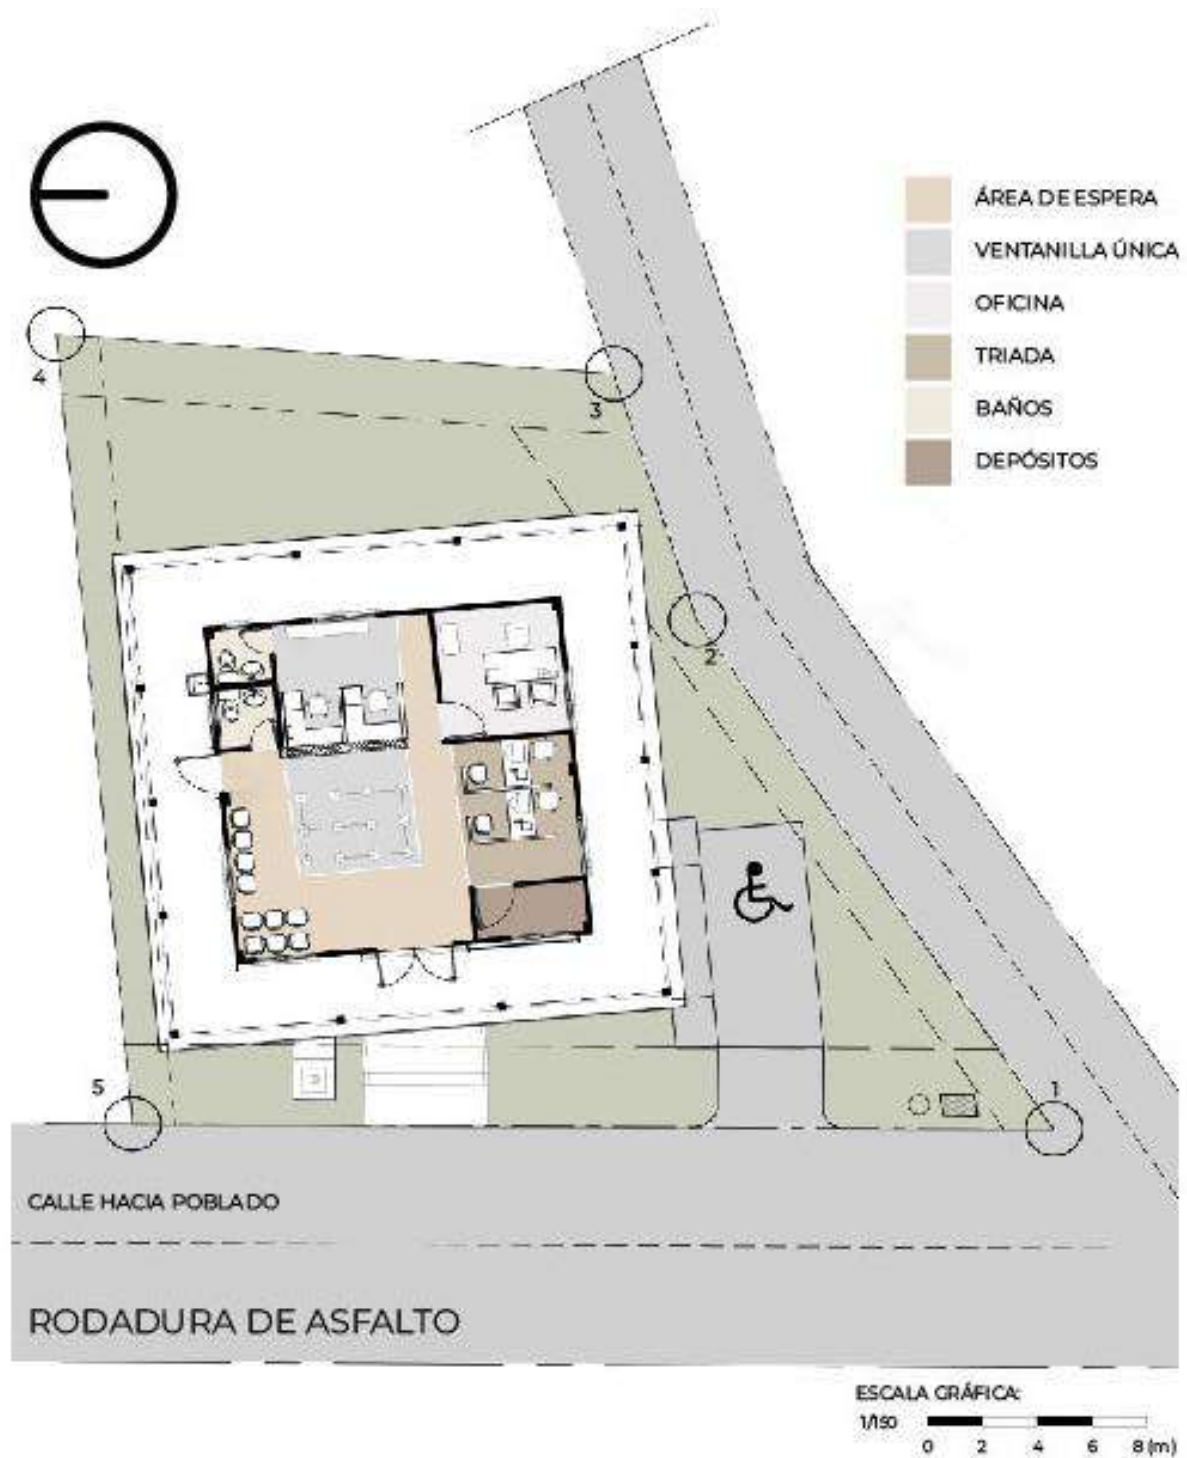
Planta baja del tribunal electoral de Pedasí. Planos de Luis Villar [Brindado por la Dirección de Infraestructura] [Elaborado por autor Helen Arispe]
